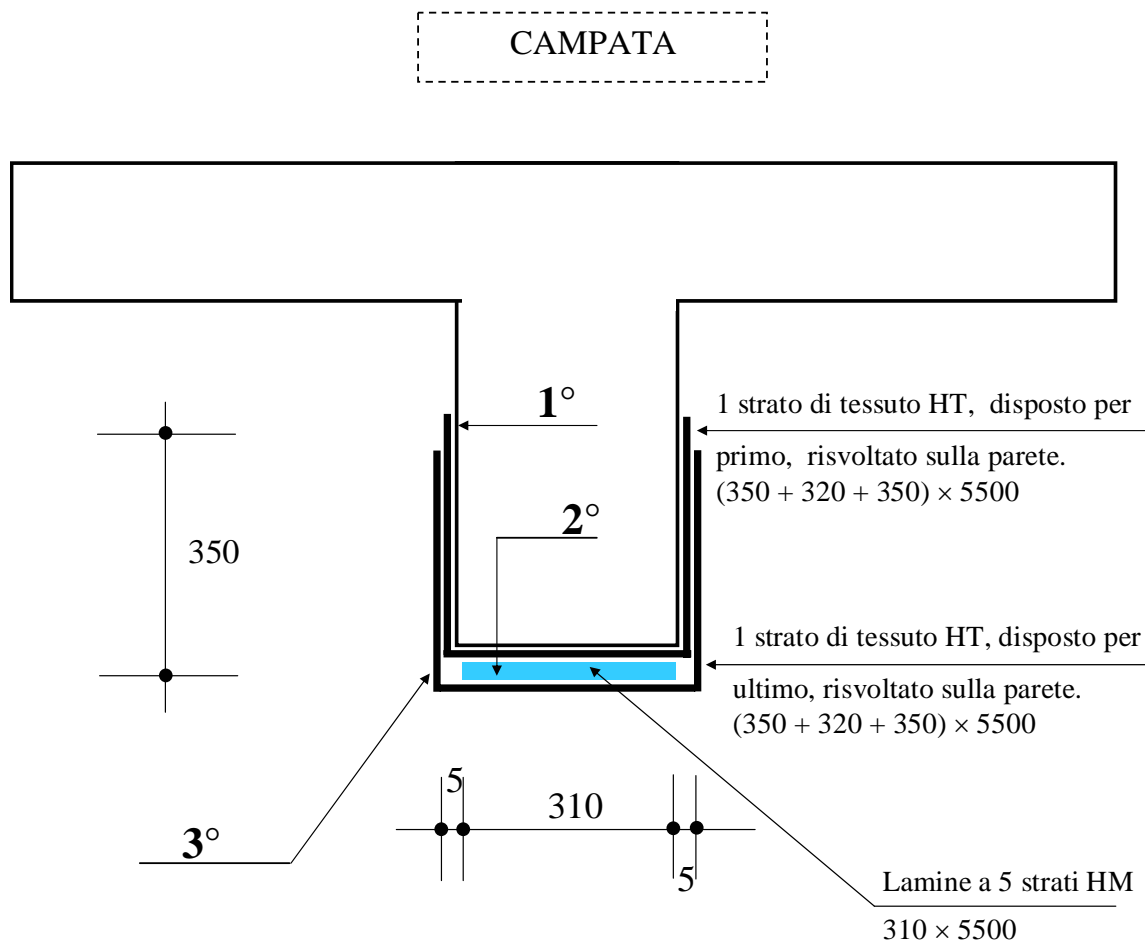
f: Sezione trasversale della trave. Intervento finalizzato all'incremento della portanza flessionale delle travi. Stato delle travi al termine della I fase.
